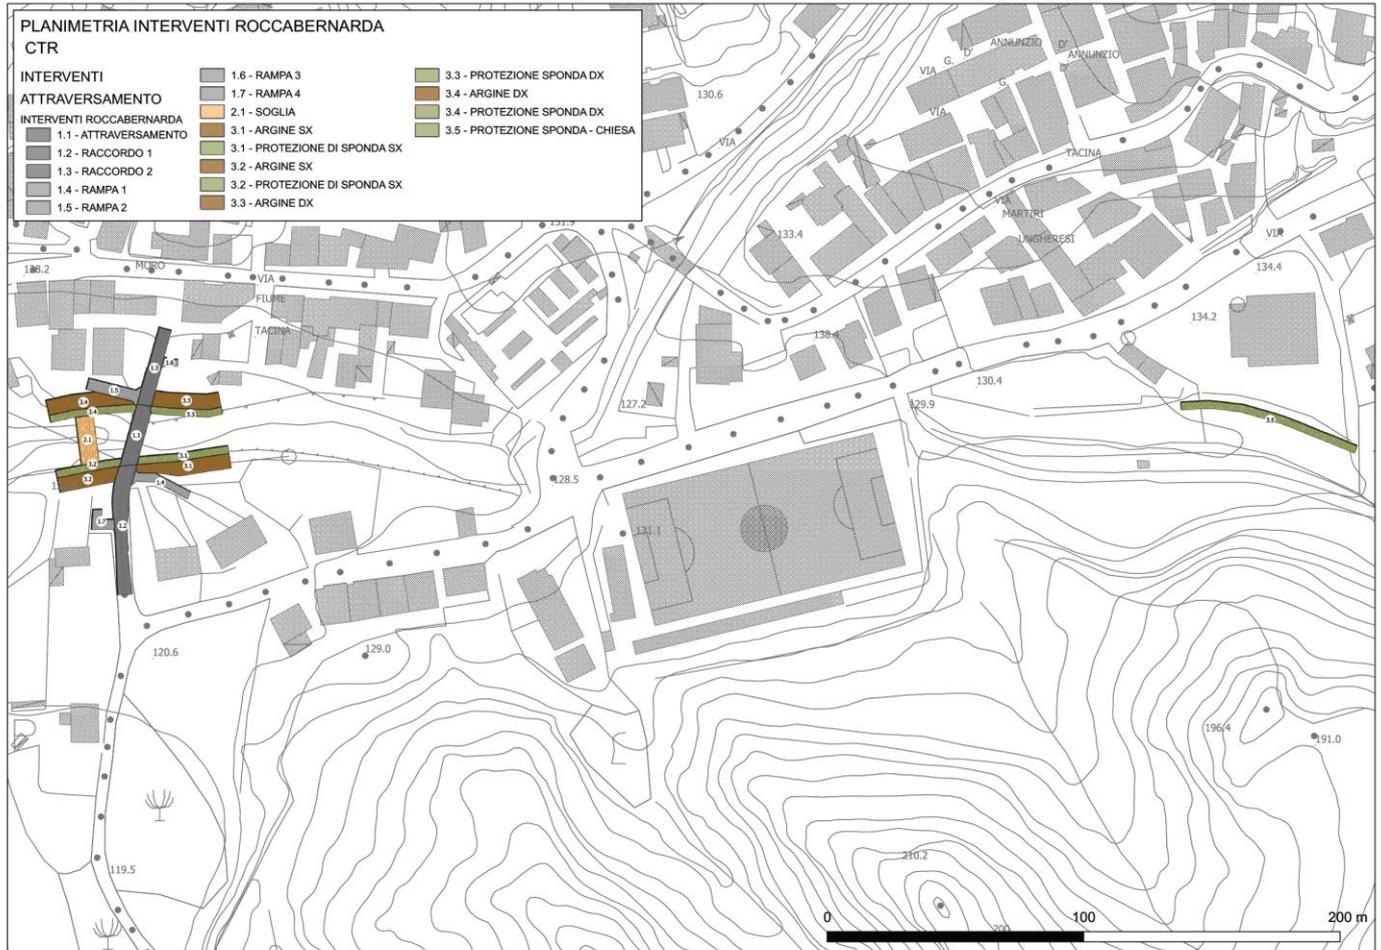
Planimetria generale interventi previsti in Località San Vito – RoccaBernarda (KR)
